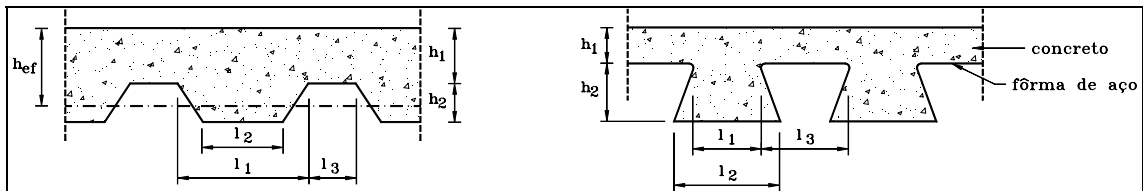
Dimensões da seção transversal da laje (ABNT, 1999).
